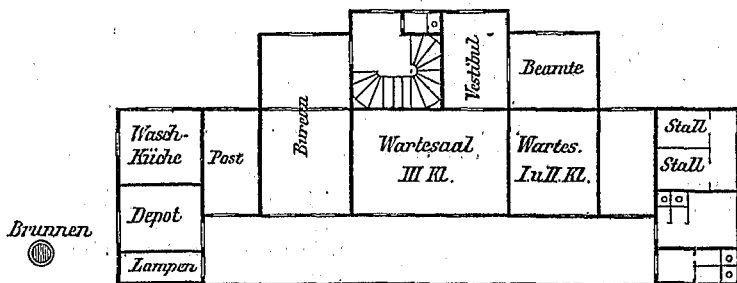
Aufnahmegebäude II. Kl. Grundriss.
